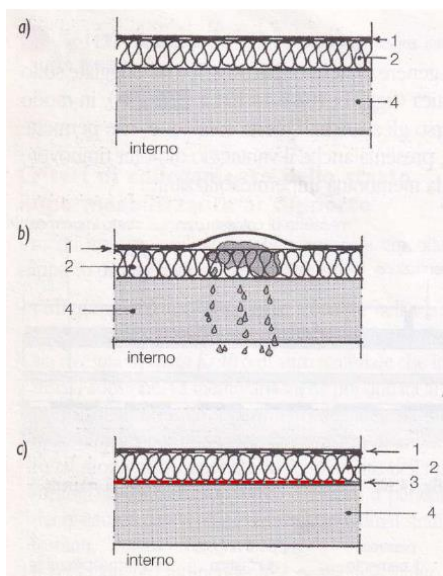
Impermeabilizzazione realizzata in modo scorretto (a) e conseguenti alterazioni (b). Corretto posizionamento della barriera al vapore (c). 1) Strato impermeabilizzante; 2) strato di isolamento termico; 3) barriera al vapore; 4) soletta.
